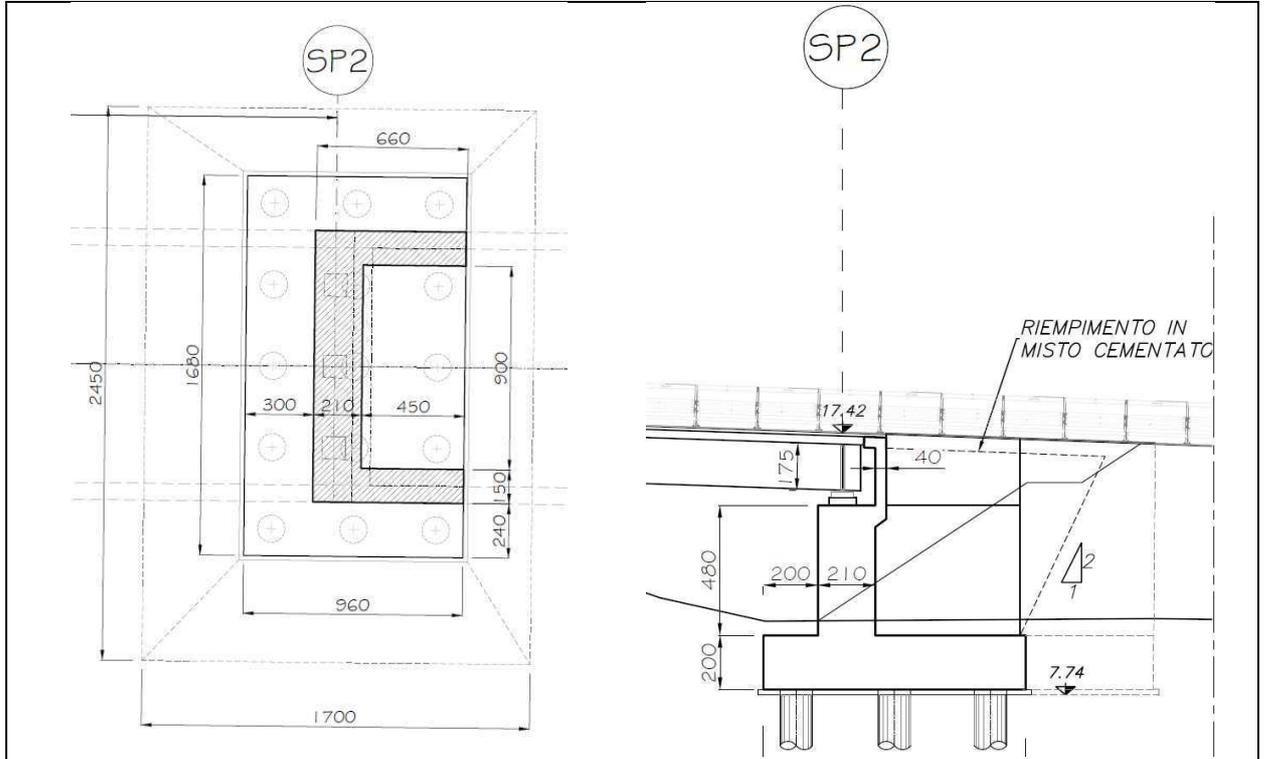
Spalla 2 - Pianta Fondazioni Sezione
